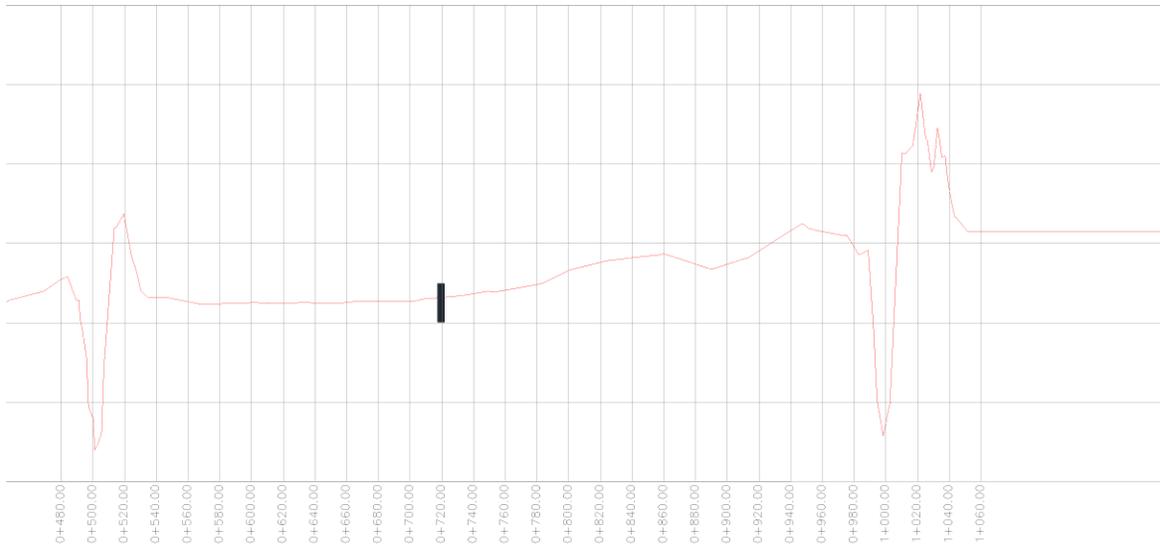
Sección de levantamiento topográfico de área de dren.
